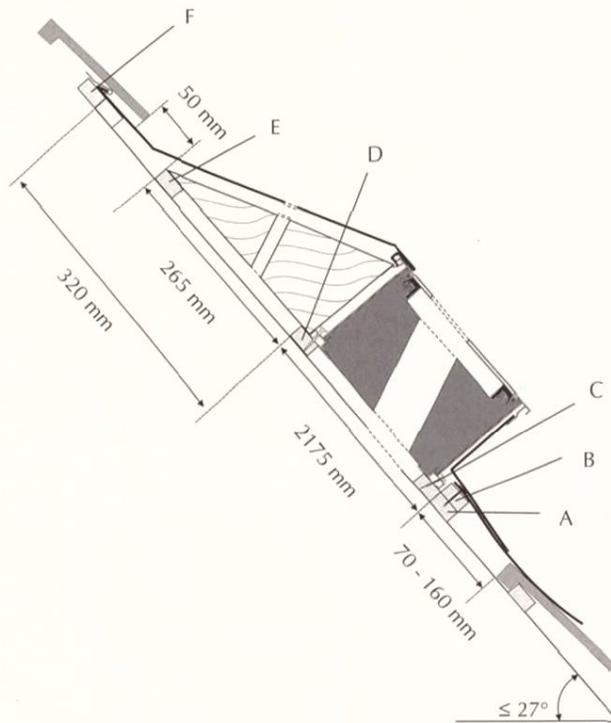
Längsschnitt durch Indachmontage. Die Buchstaben A - F geben die Lage der Einbaulatten an.
